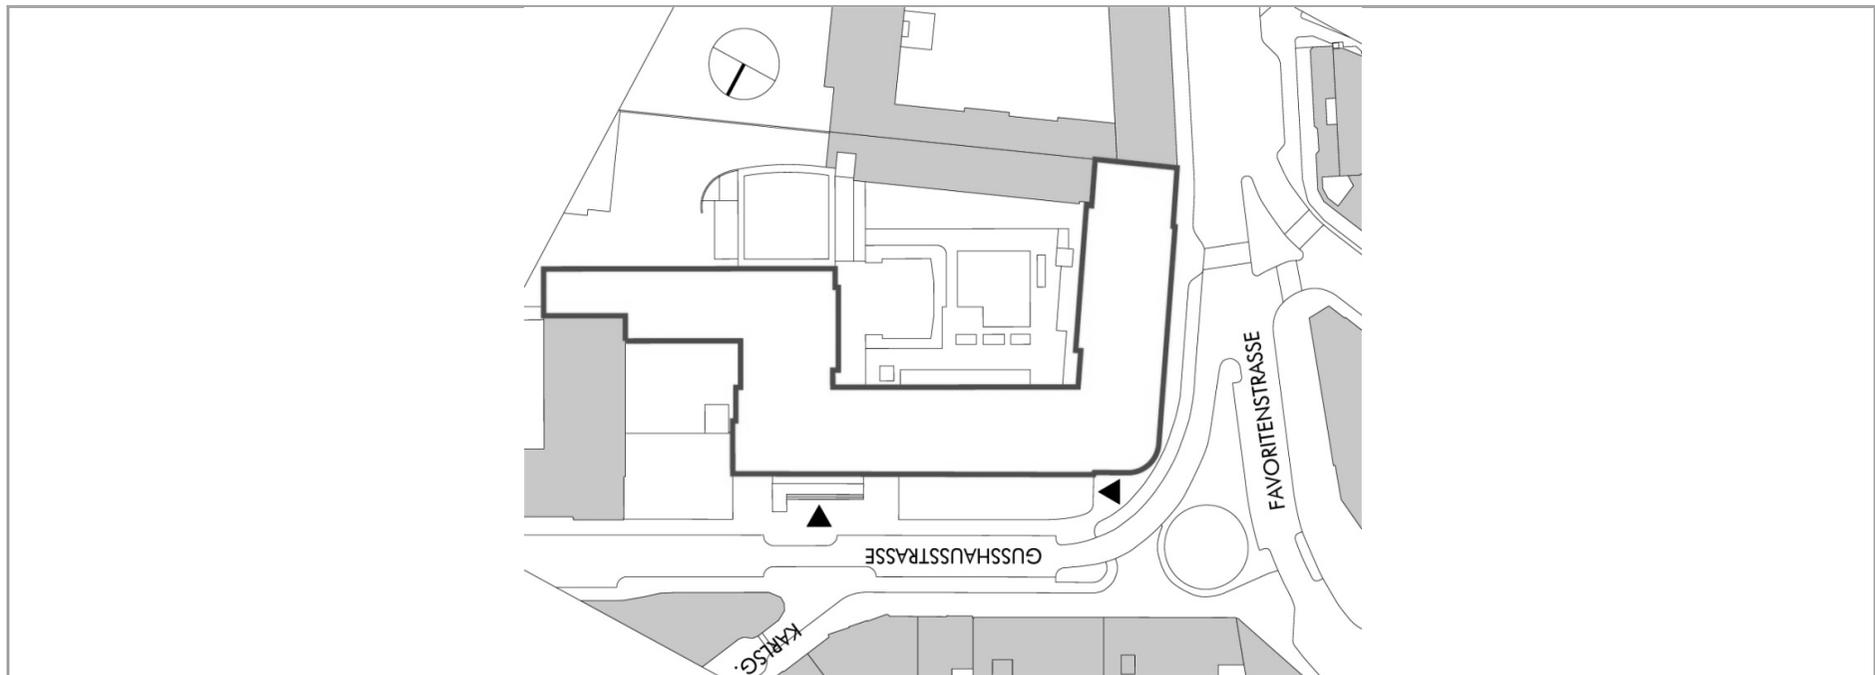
Dachaufbau Schneider – Lageplan (Key Station der TU Wien, 2008)
